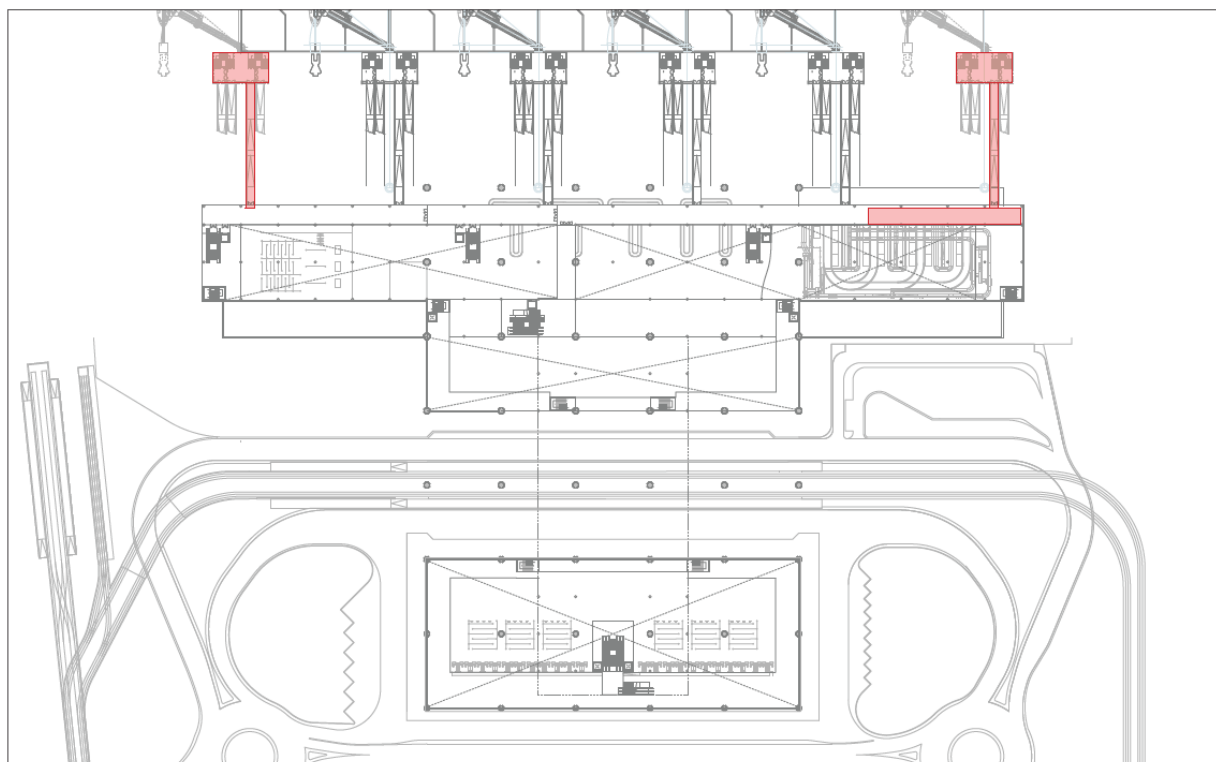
| Planimetria del Piano mezzanino 2026 - Area di flessibilità operativa
